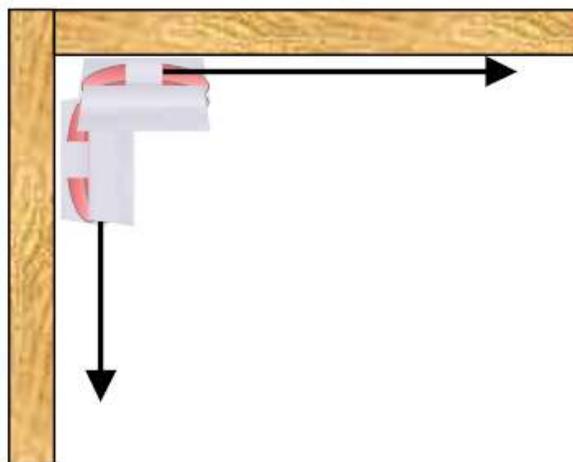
Schéma d'une installation sur deux murs perpendiculaires
